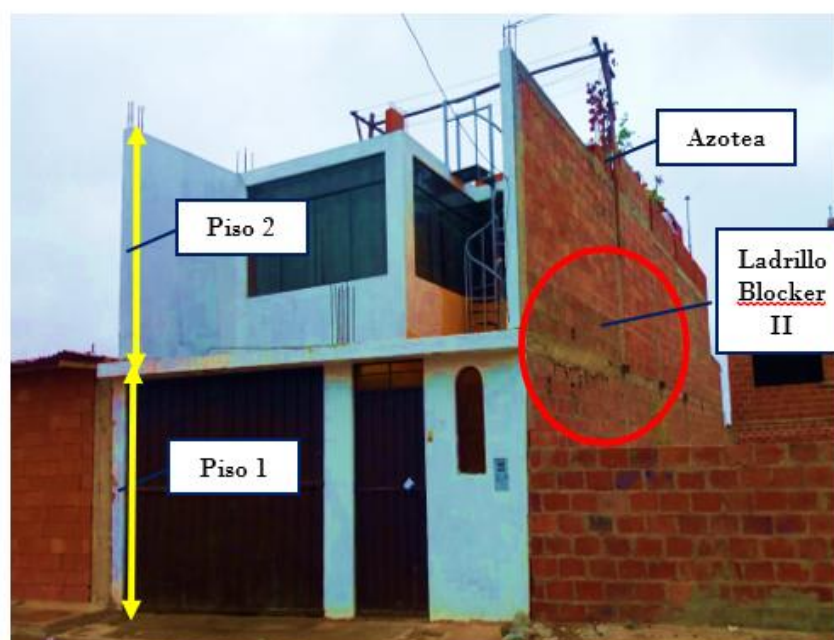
Vista de vivienda 14. Vivienda construida con Blocker II, presenta 2 pisos y 1 azotea.
